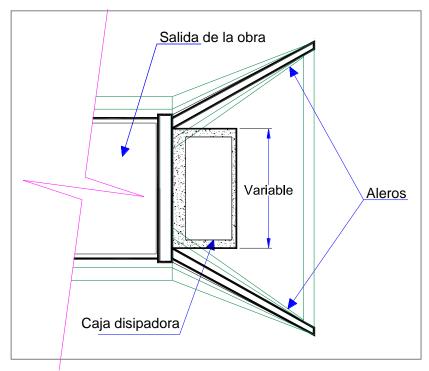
Vista en planta de caja disipadora en obras de drenaje transversal., Detalle, 2017
